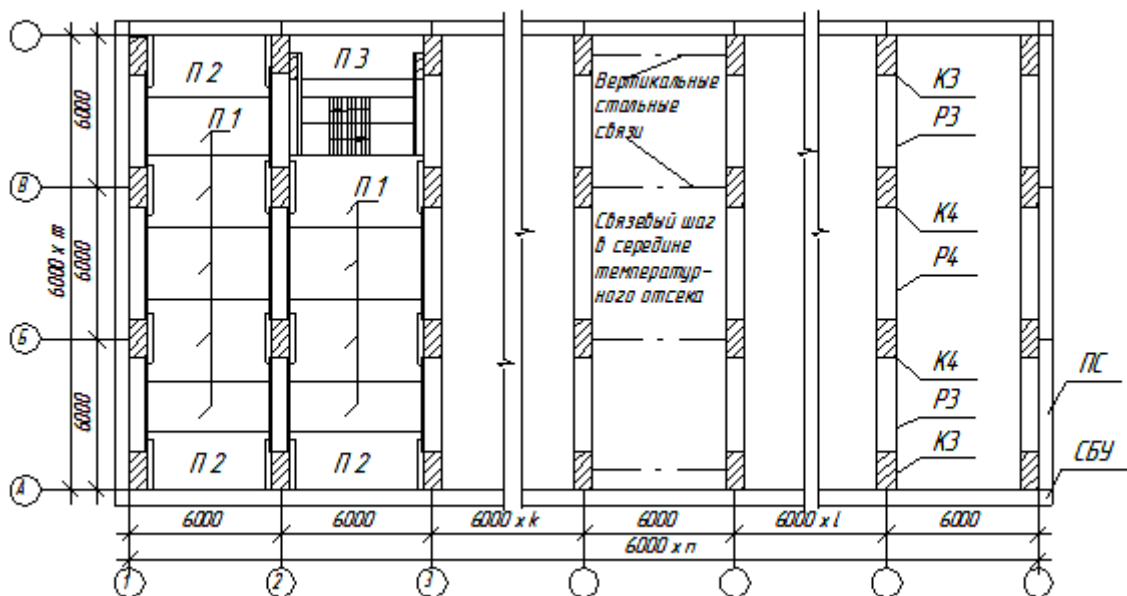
Схема плана с сеткой колонн 6×6 м (вариант 1)
